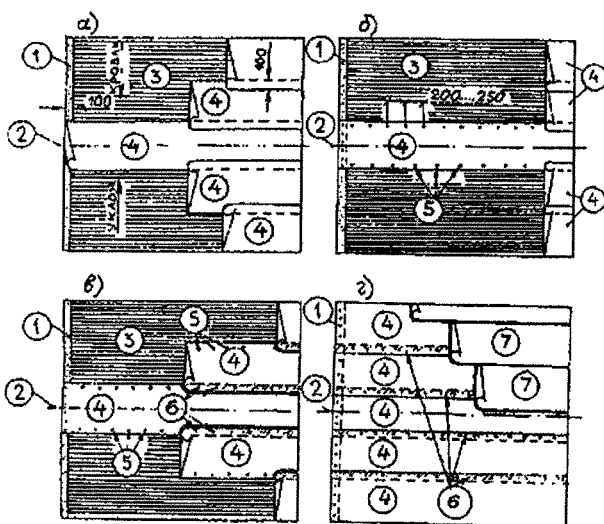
Пример раскладки рулонных материалов при устройстве водоизоляционного ковра с механическим креплением нижнего слоя
